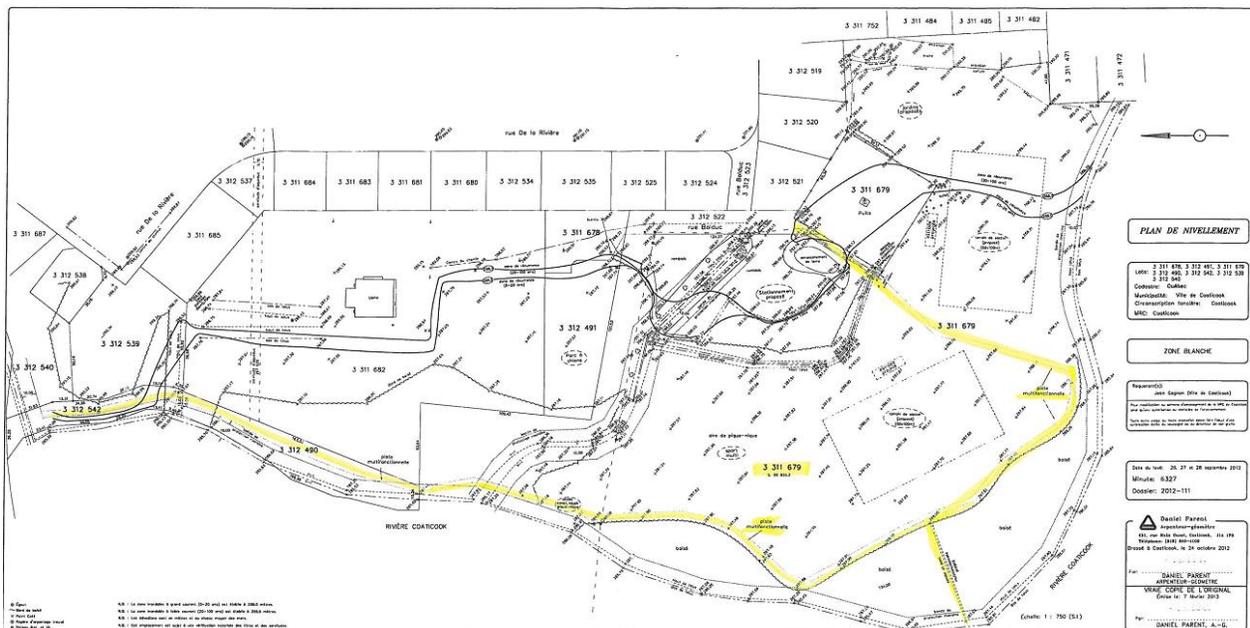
Aménagement du sentier multifonctionnel
